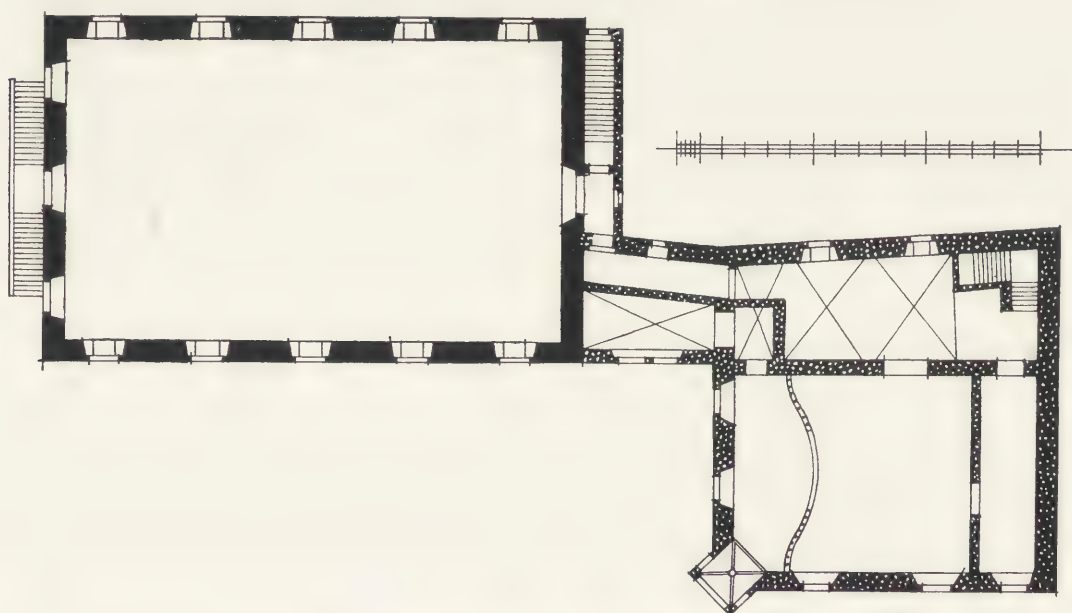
Rathaus zu Cham. Grundriß des ersten Stockwerkes.
